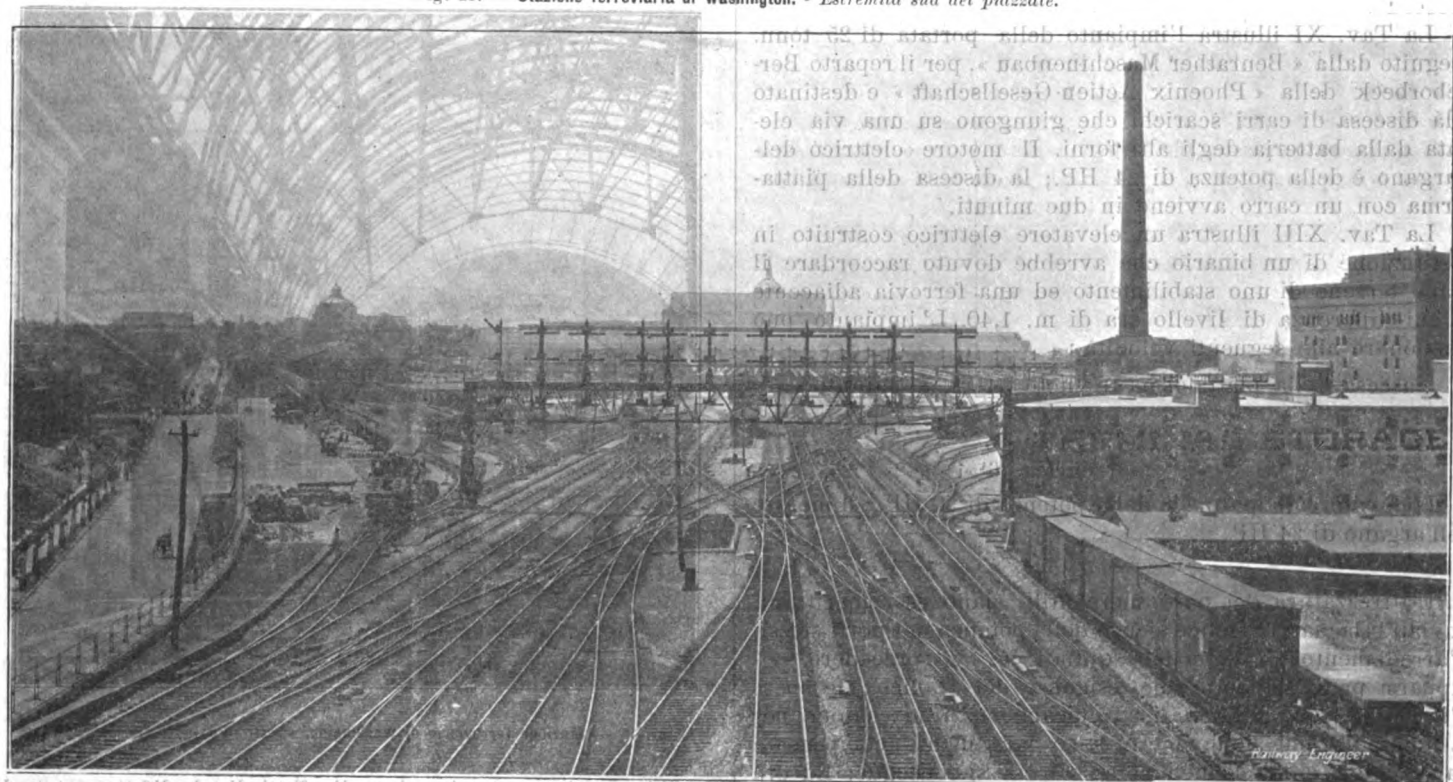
Stazione ferroviaria di Washington. - Vista generale.
